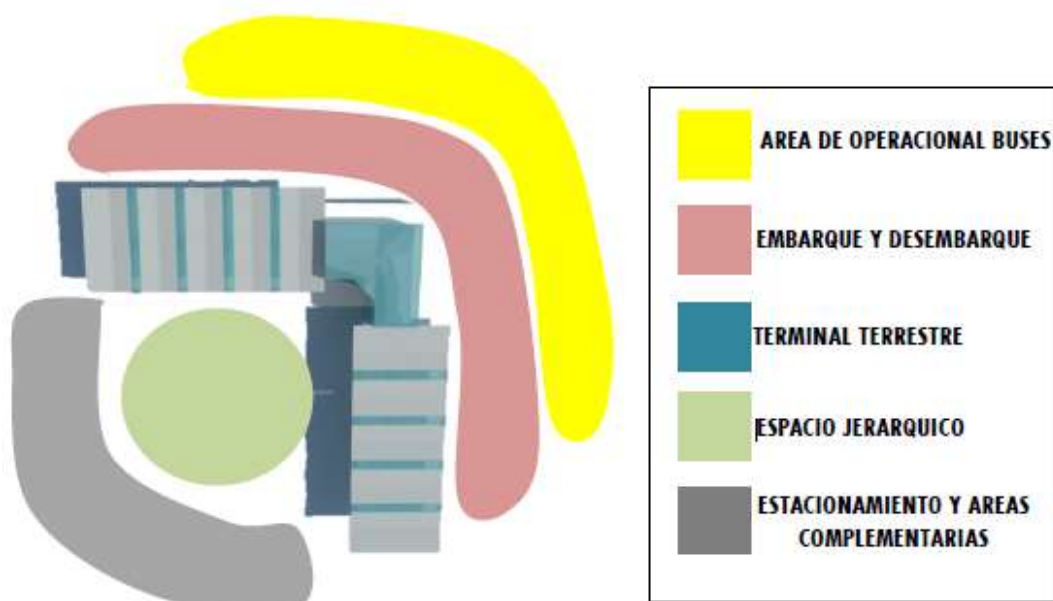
vista en planta del proyecto arquitectónico del terminal terrestre de Chimbote, 2018. Fuente: Elaboración propia.
